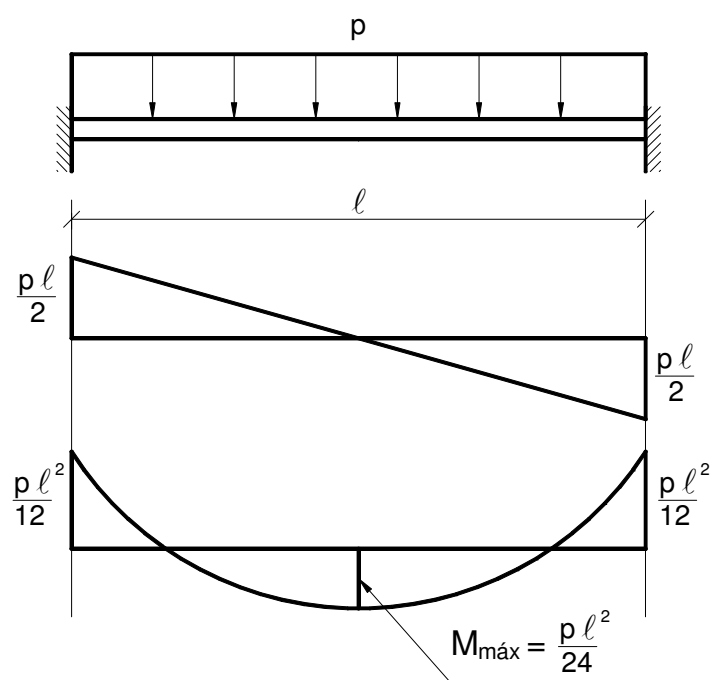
Laje armada em uma direção biengastada com carregamento uniforme.
